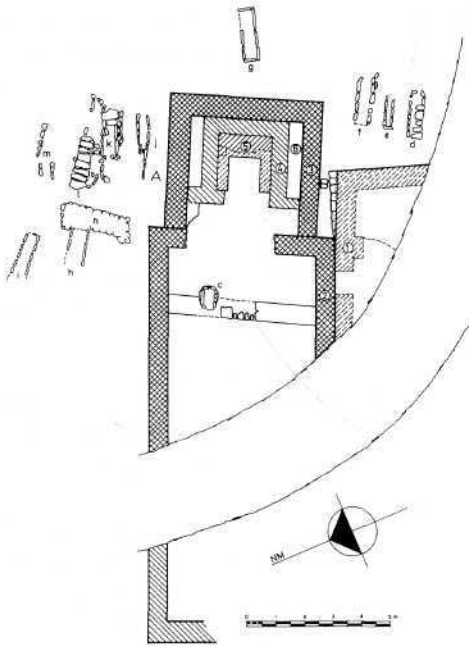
Planta general del jaciment segons Lluís Esteva (1993).
